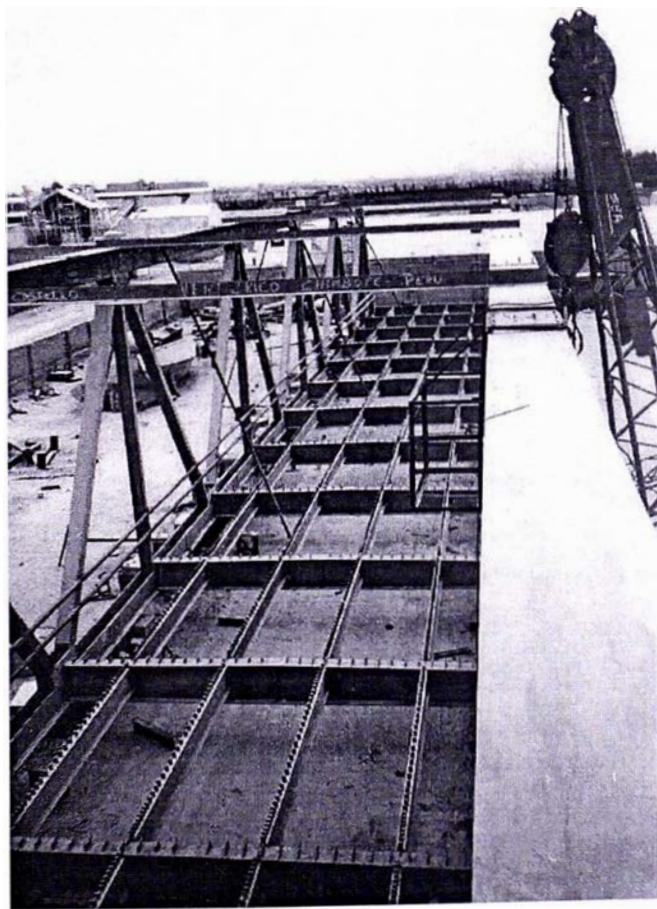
Ensamblaje de la Estructura Metálica Reticulada
